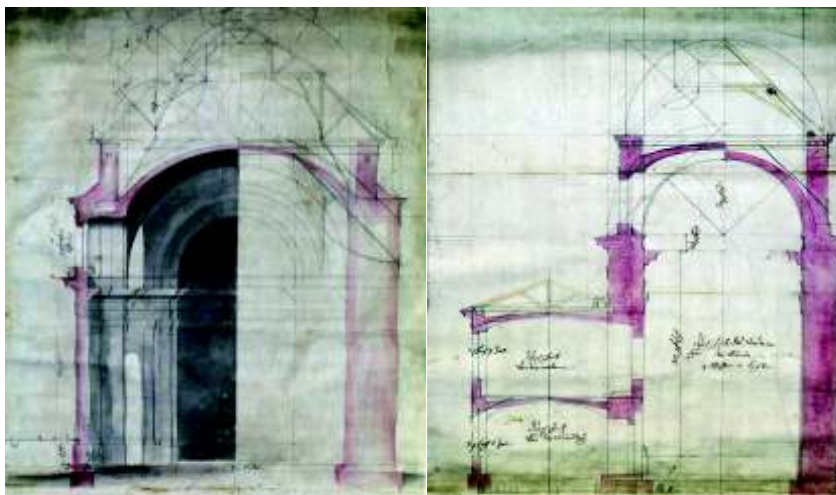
Plan original (înainte de 1769) – secțiuni transversale ale bisericii piariste din Carei
